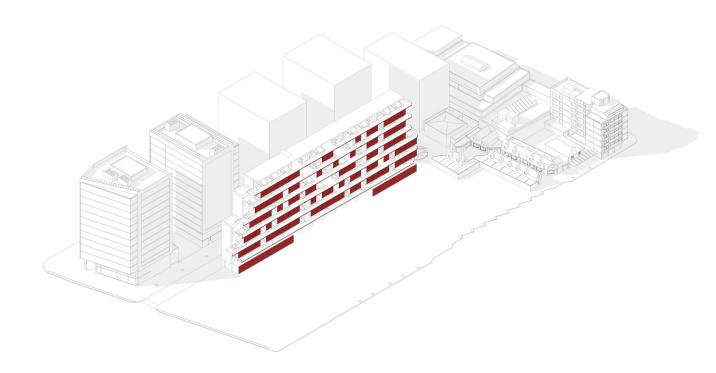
Esquema en axonométrica de seccion longitudinal de proyecto. Elaboración propia
